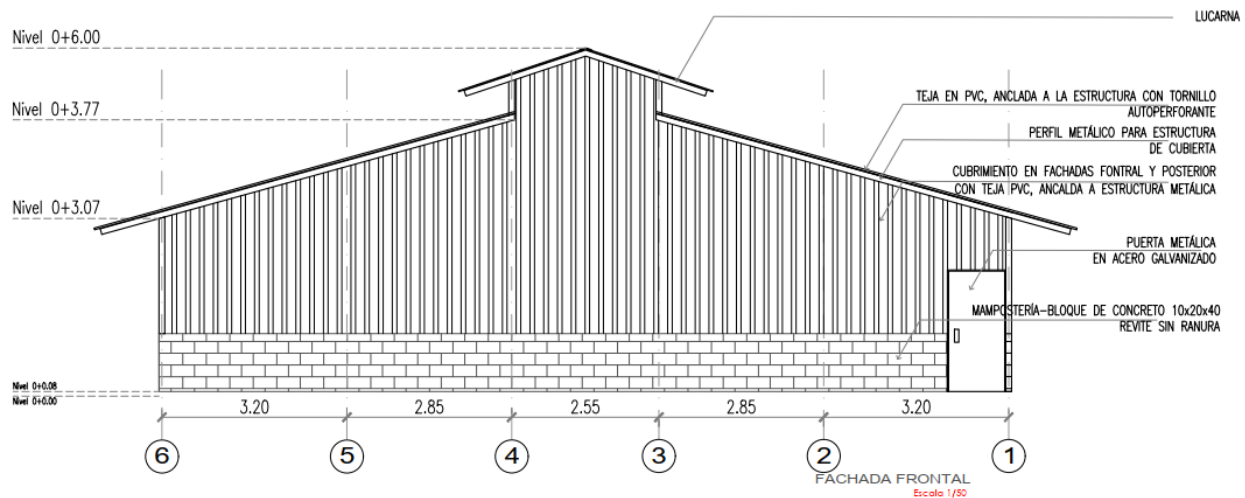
Fachada frontal del caso ejemplo, Fuente: Elaboración propia de autor.
